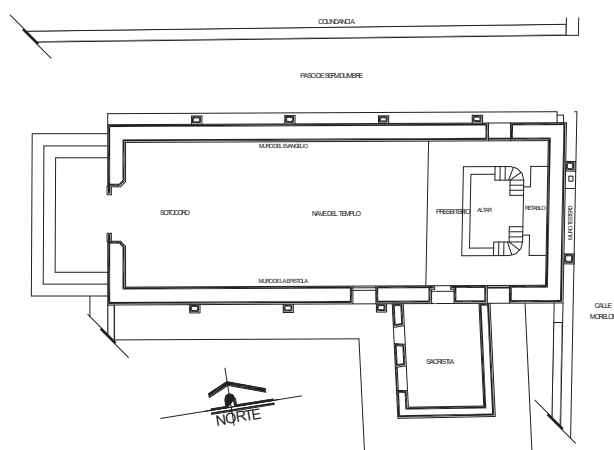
Disposición oriente poniente de la planta de Templo de Santo Tomás
